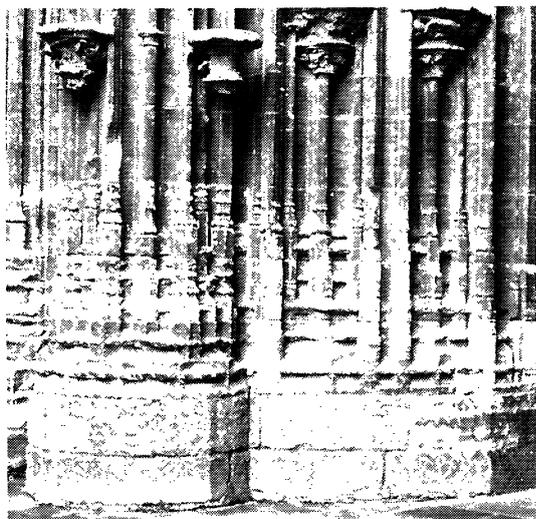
Detalle del intenso burilado sobre la dolomía de Laspra, en las jambas de la puerta central del pórtico.
